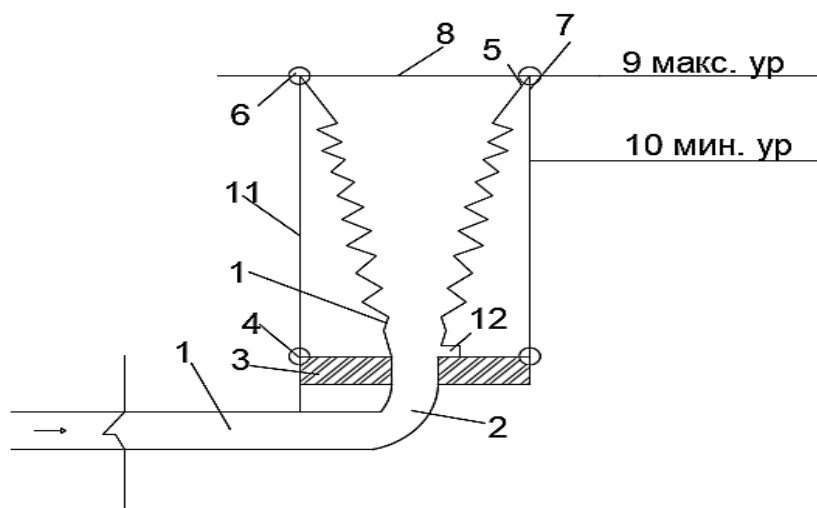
Схематическая конструкция водовыпуска камерного типа с гибкими стенками
